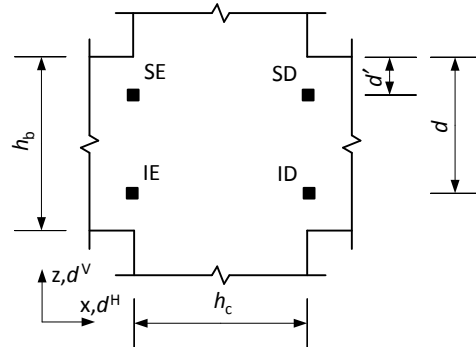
Pontos de monitorização nos modelos de EF no plano do pórtico.
